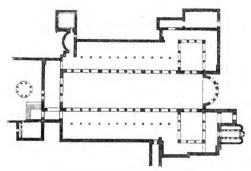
St. Demetrius in Theffalonich. Grundriss,
